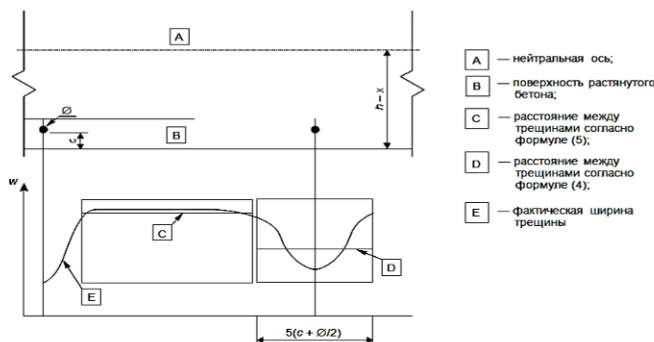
Ширина трещины w на поверхности бетона по отношению к расстоянию между стержнями
